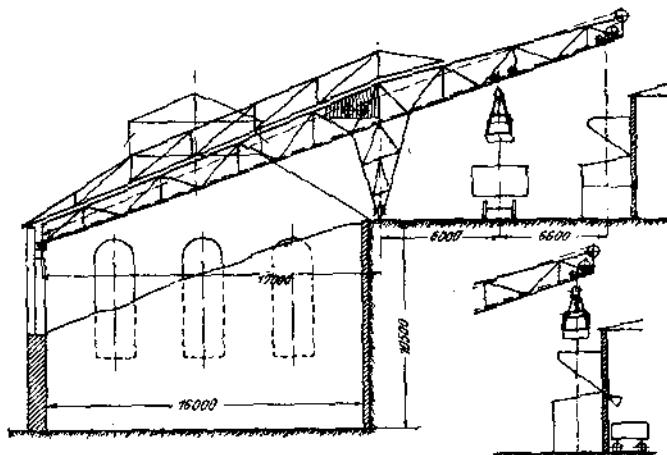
Механическая разгрузка вагона над угольной ямой.
